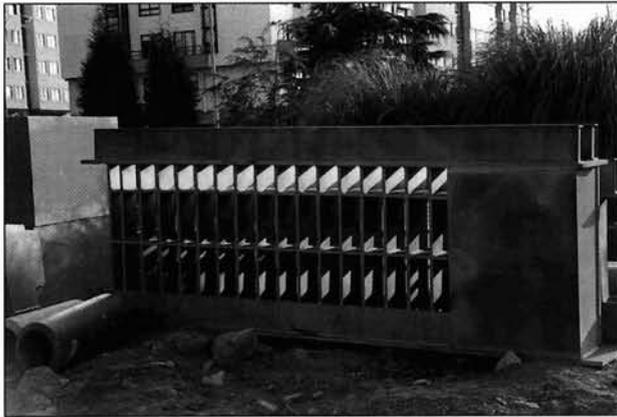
Elemento de conexión estructura metálica rampas-estribo de hormigón.
